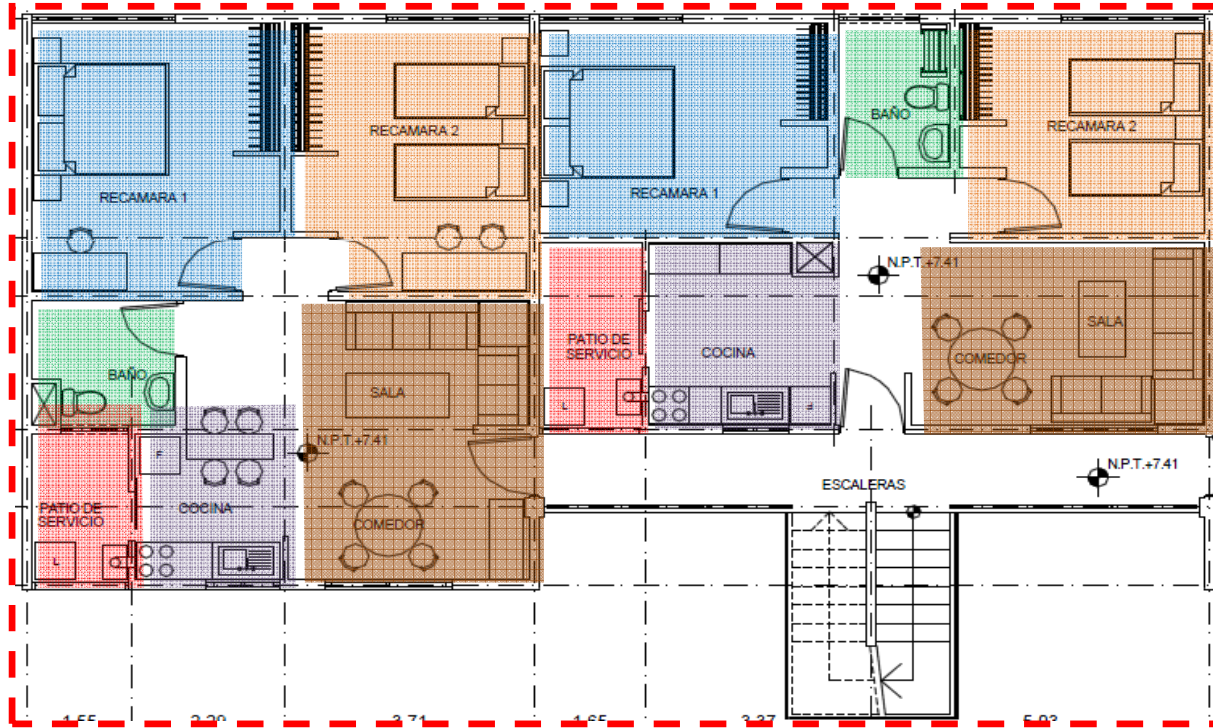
Planta del edificio tipo del conjunto y la ubicación del modulo tipo.
